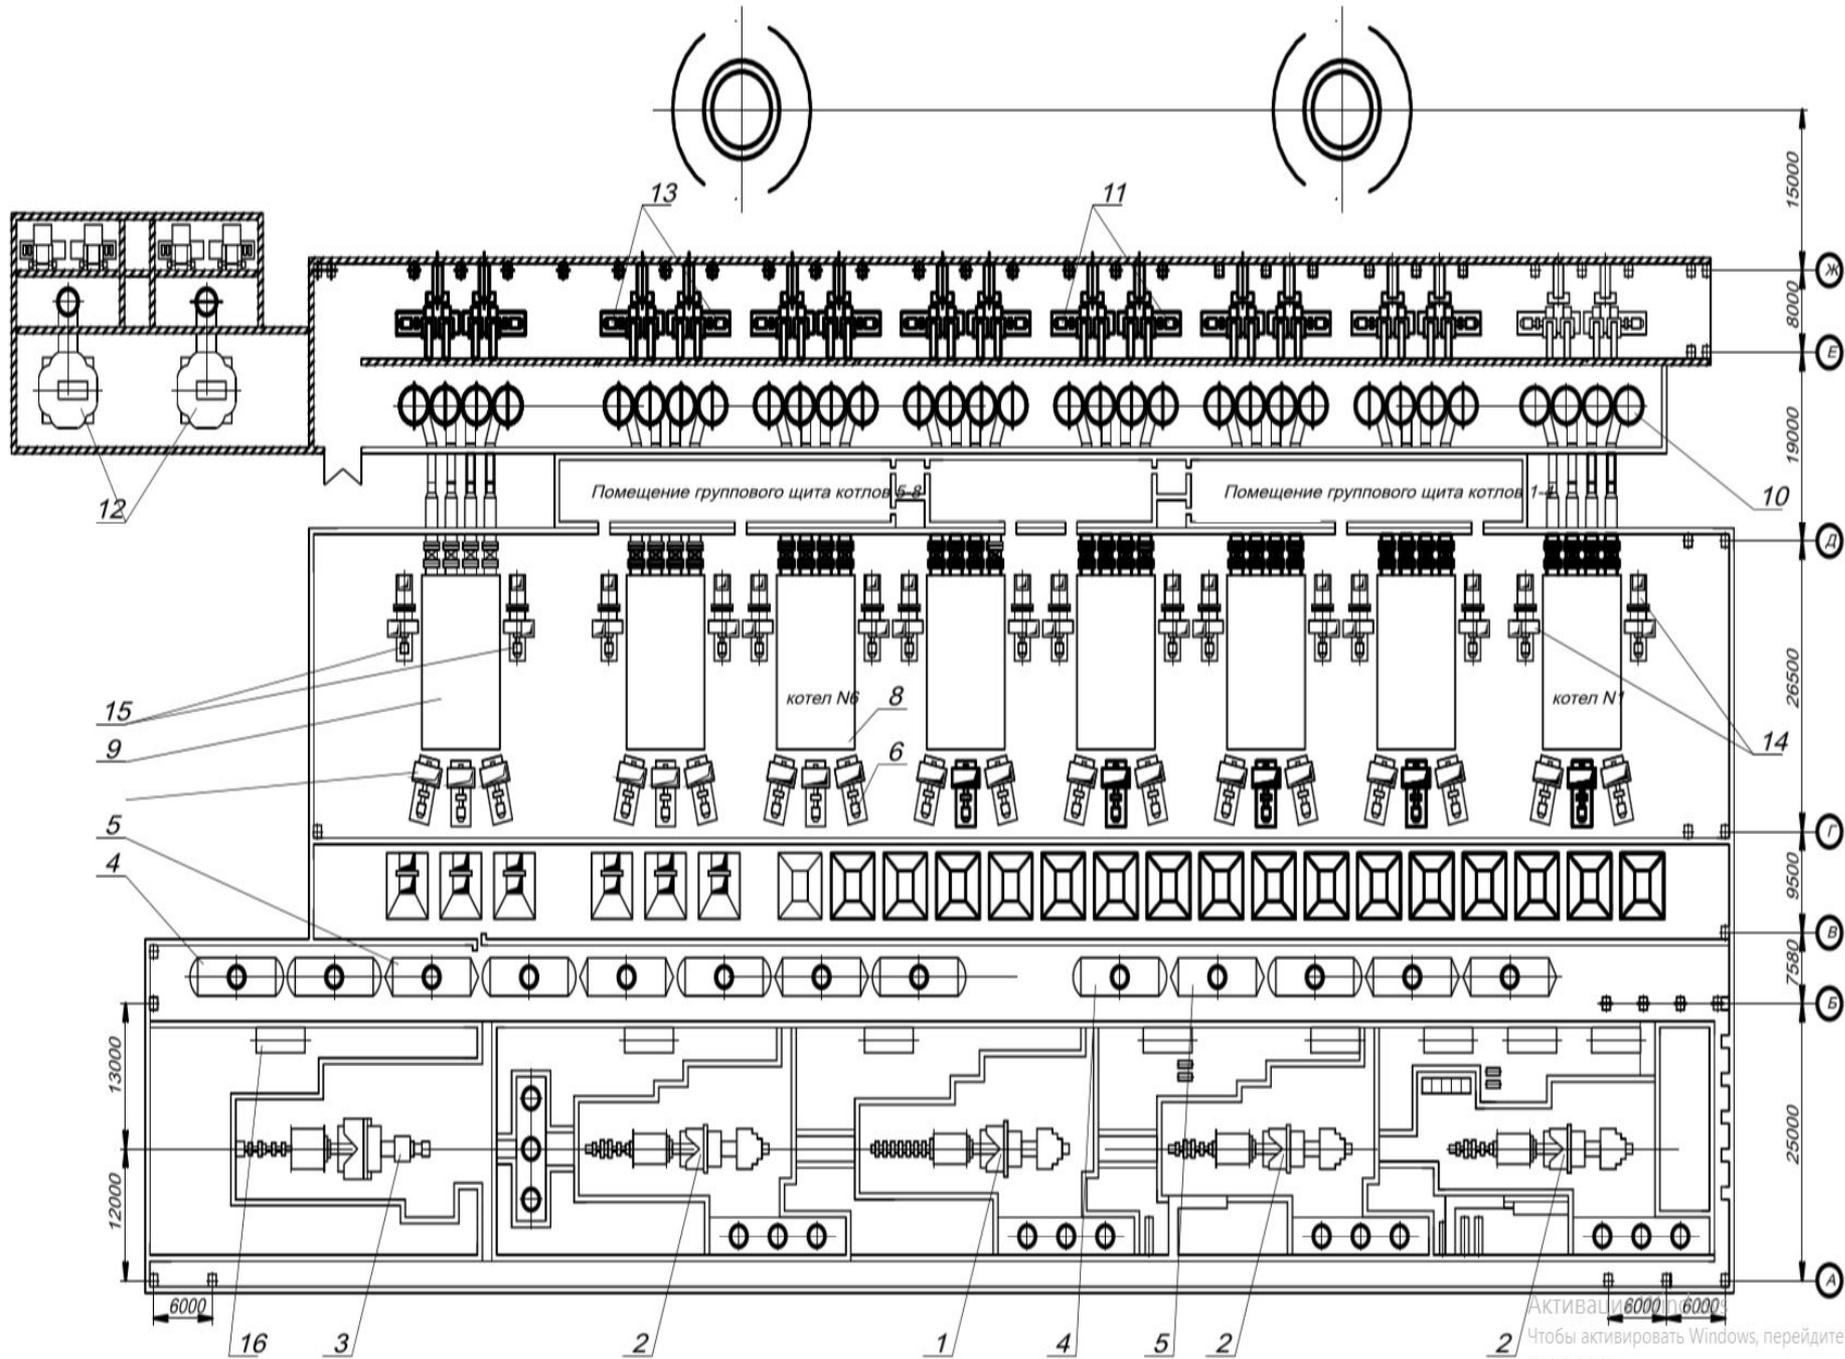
План главного корпуса Ивановской ТЭЦ-2
